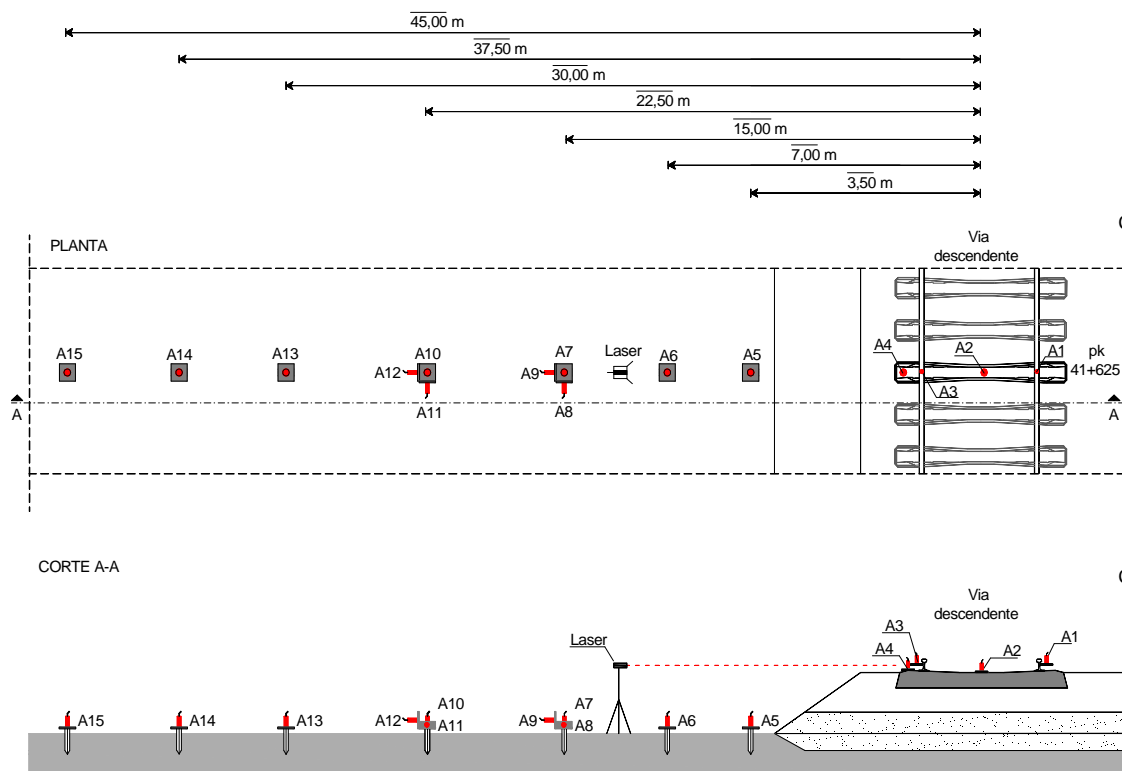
Representação em planta e corte da localização dos sensores.
